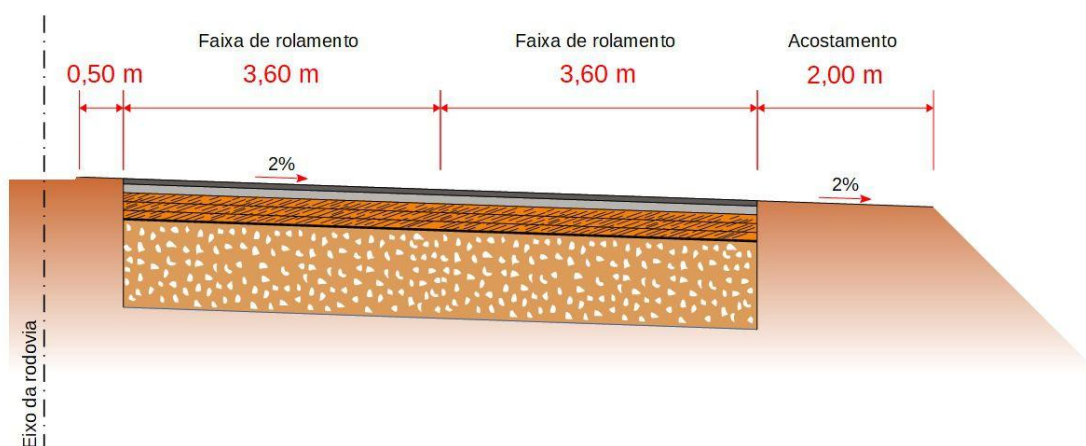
Detalhe A: seção transversal tipo do serviço de pavimentação – PCAE
